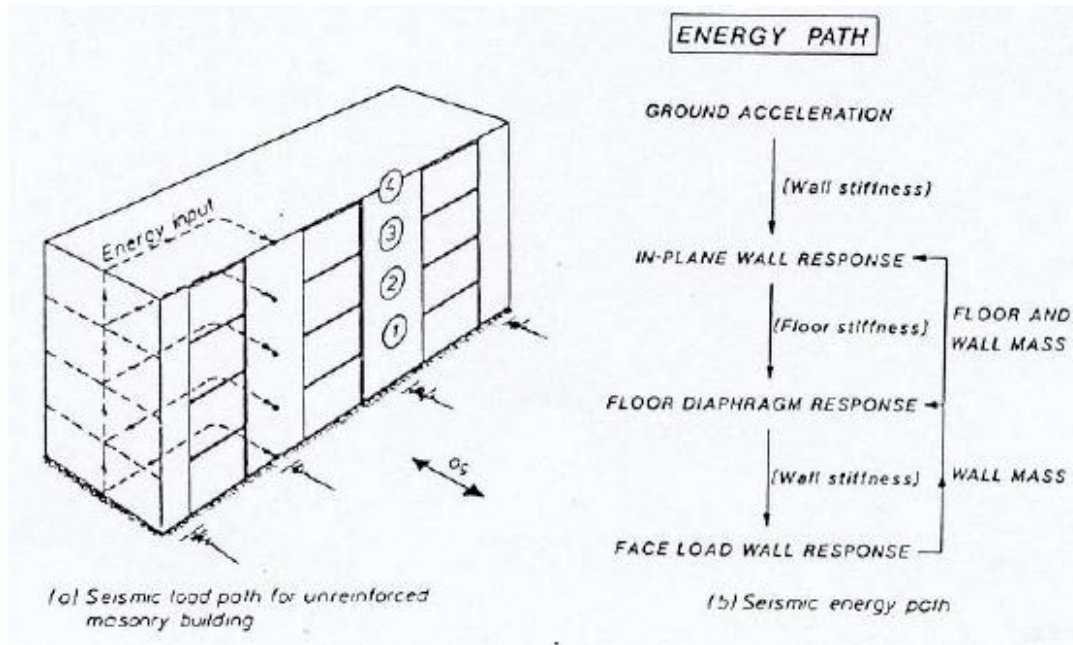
Respuesta sísmica para un edificio de albañilería sin reforzar (Paulay y Priestley, 1992)
